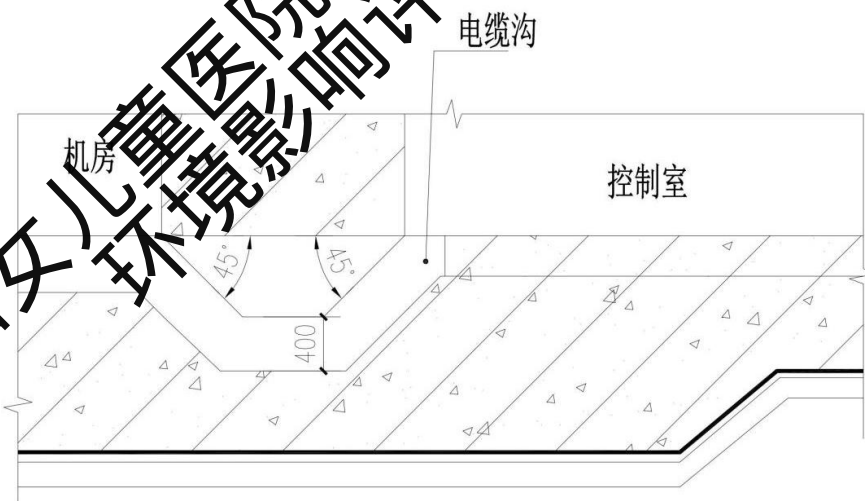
加速器机房屏蔽示意剖面图 (剖面 2-2) (单位: mm)
